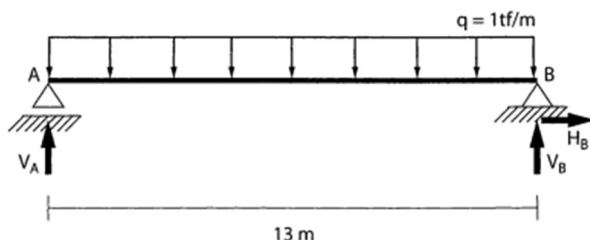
Viga biapoiada com carregamento uniformemente distribuída. Fonte: [4]
